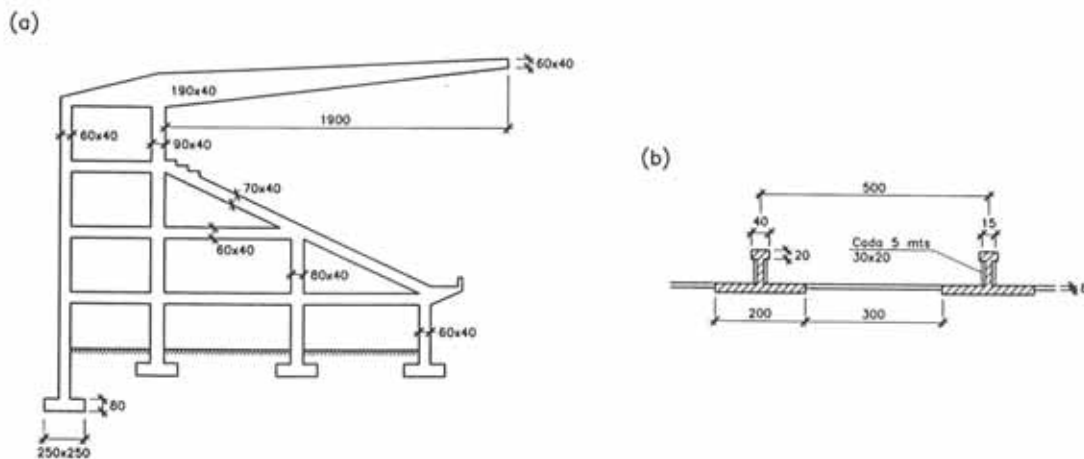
Estadio nacional de Lima proyectado en el año 1949. (a) Sistema estructural (b) Corte indicando las vigas principales del voladizo.
